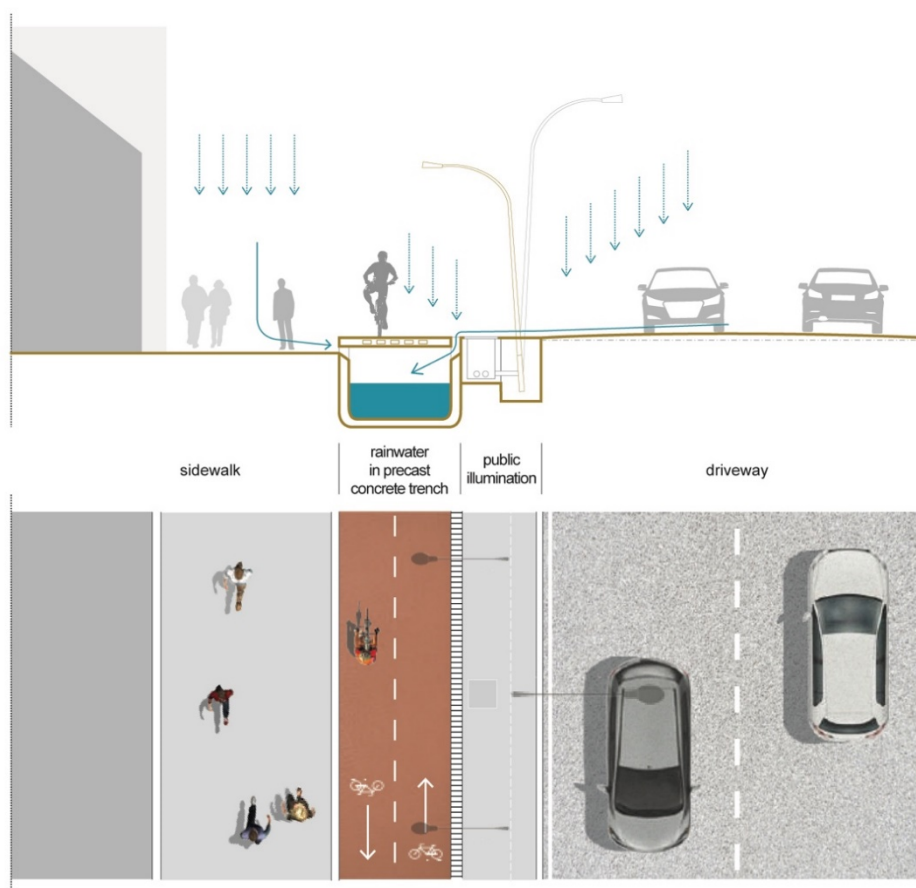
| Sezione e planimetria del progetto di un canale prefabbricato sotto la pista ciclabile di M. Colville-Andersen e S. Montebello.
